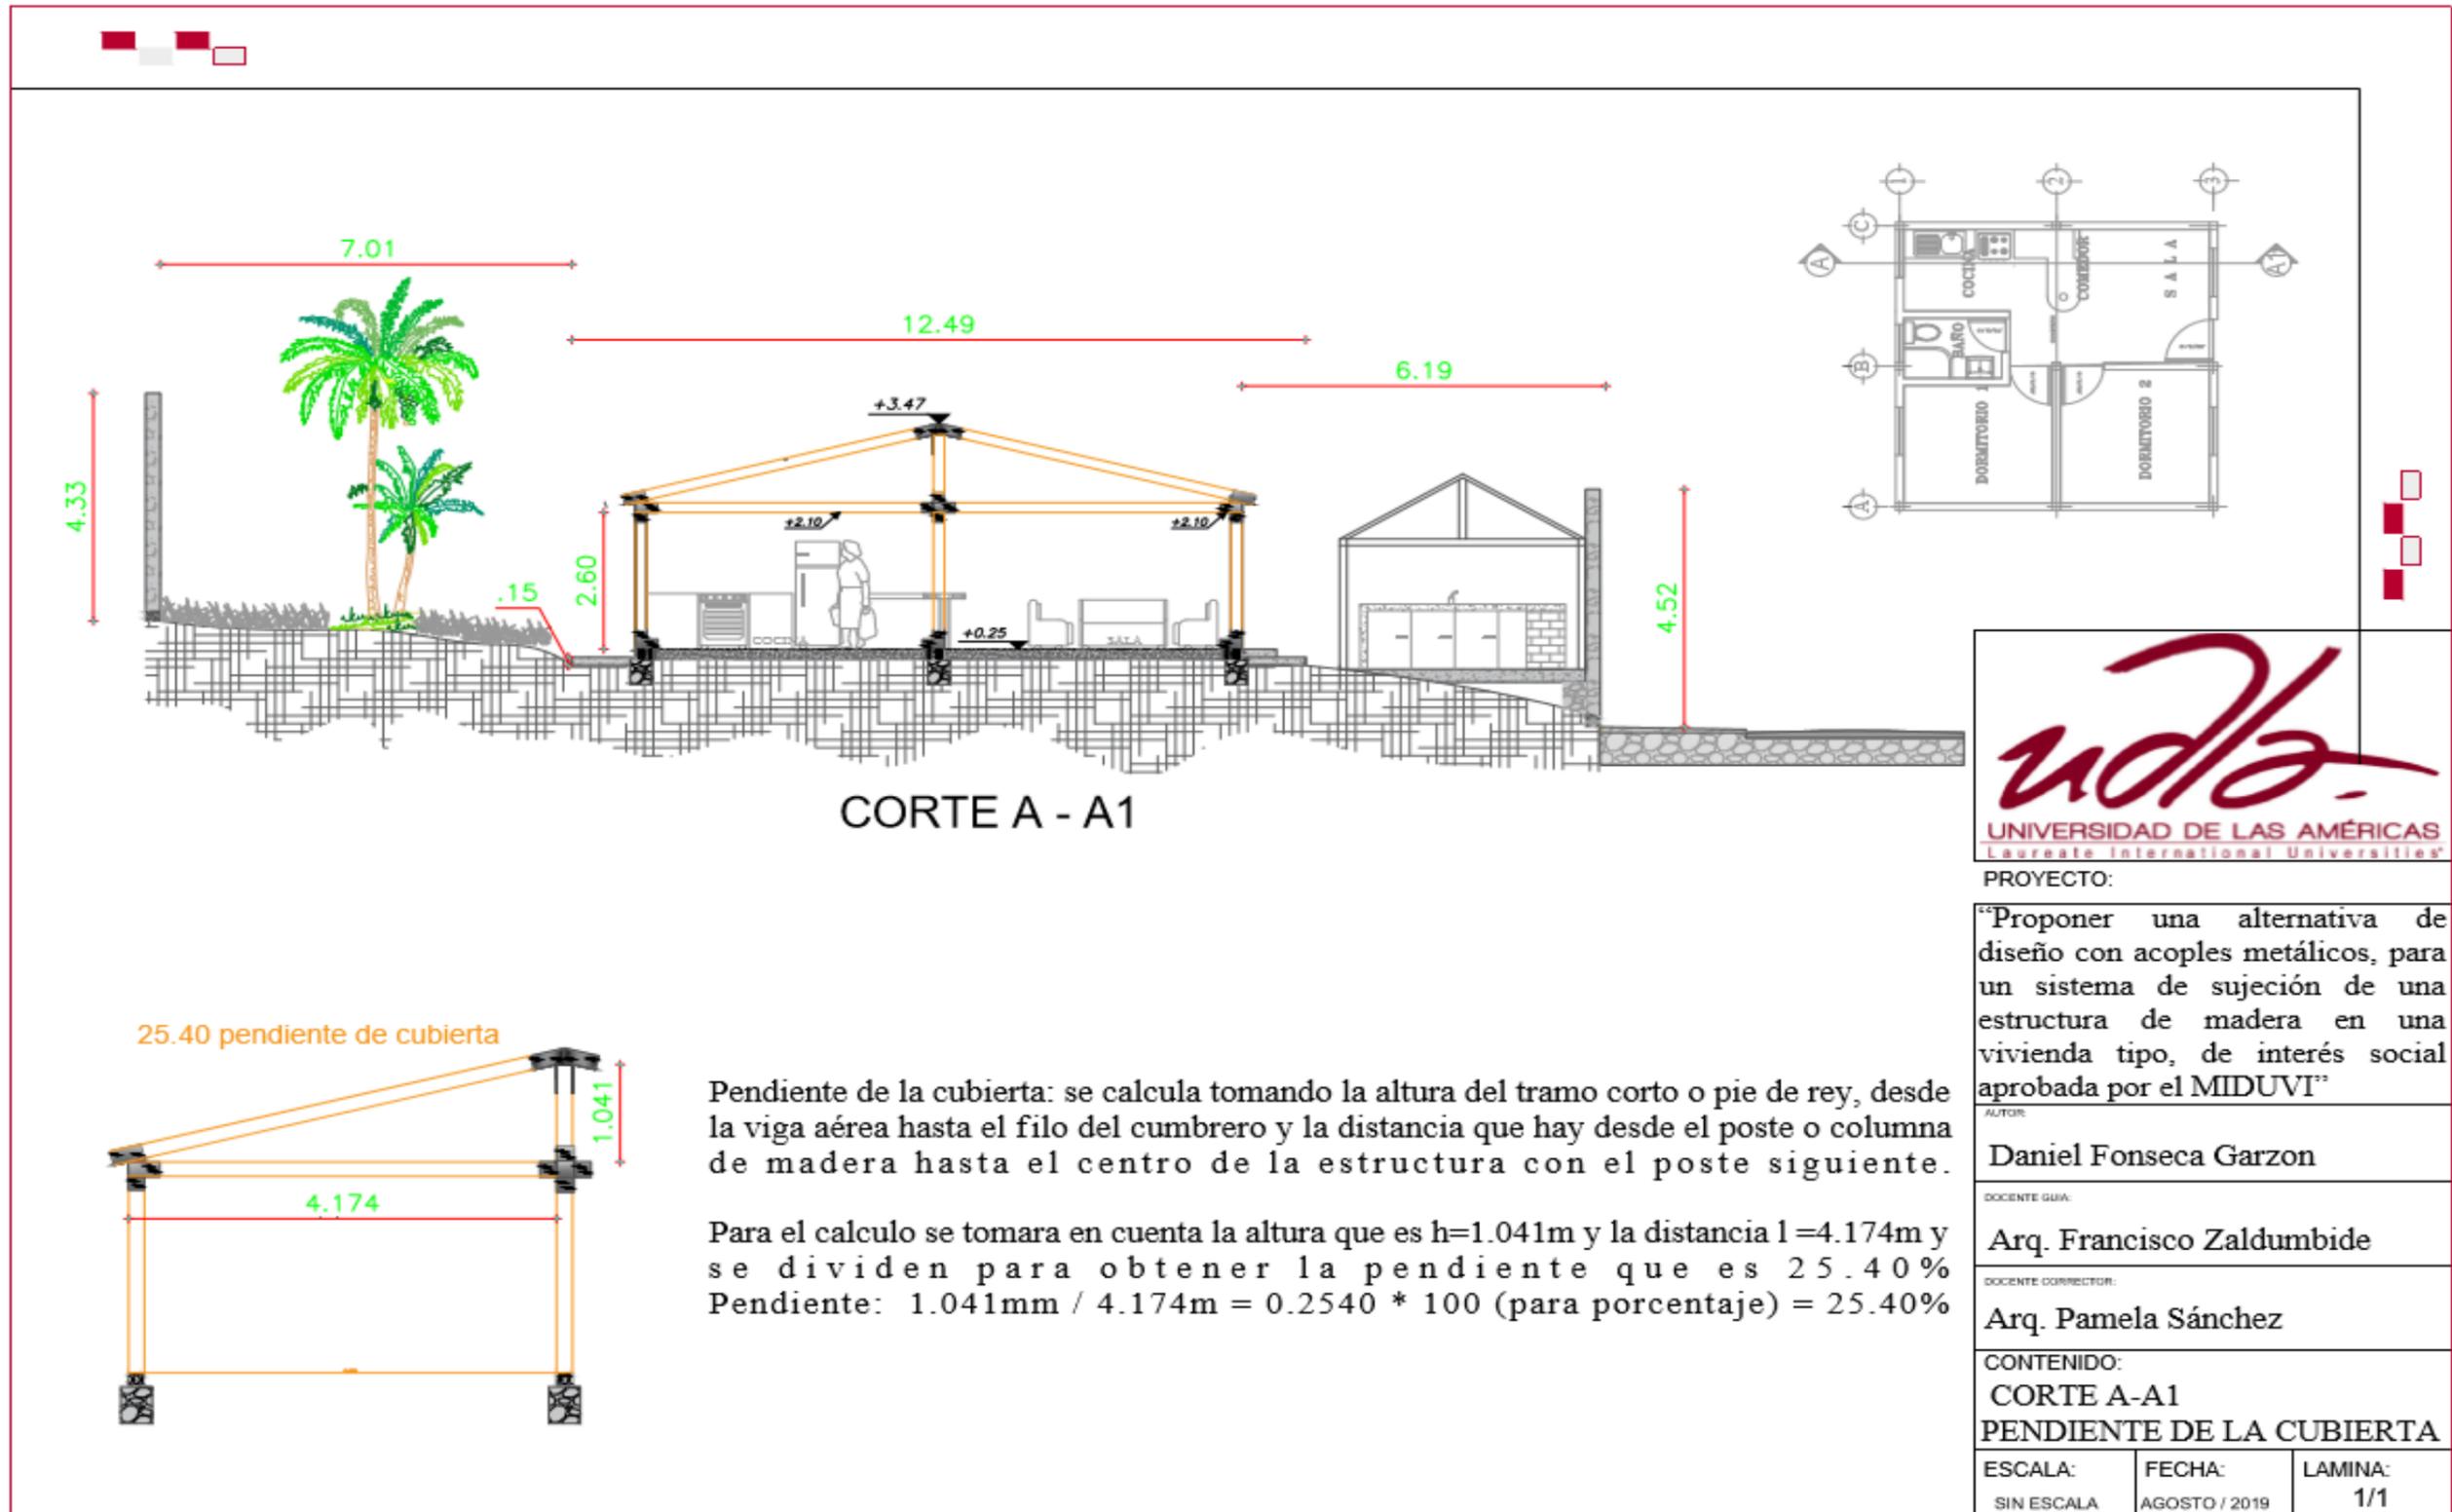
Plano detalle en corte A - A1 y pendiente de cubierta
